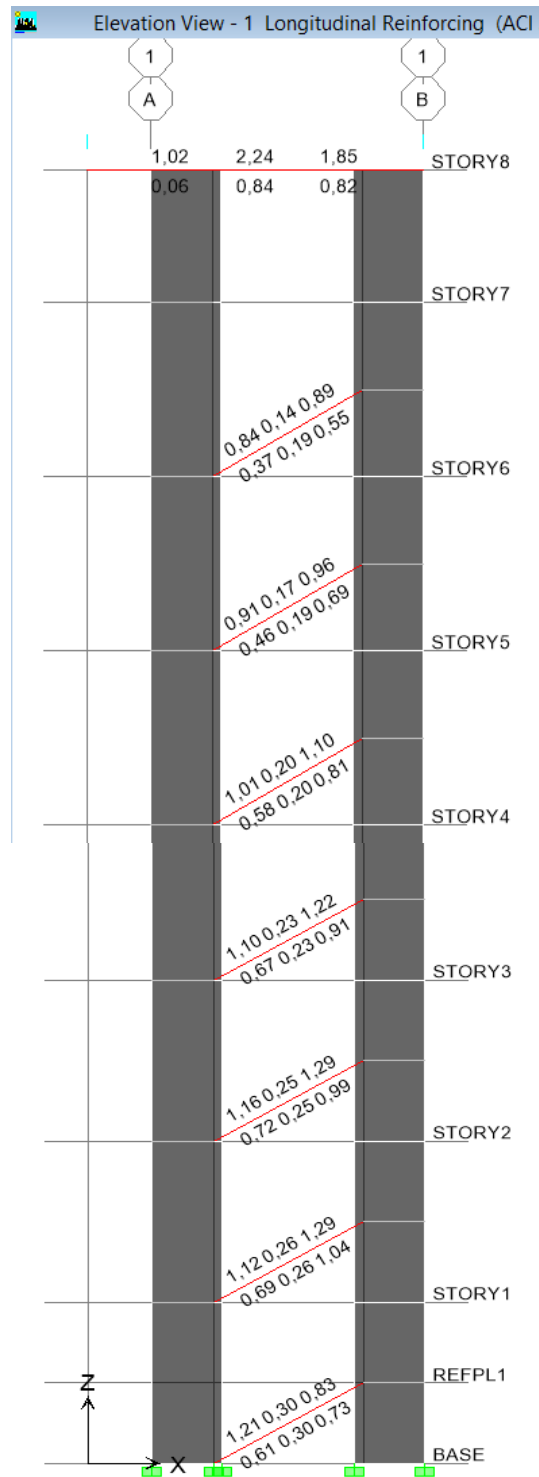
Acero en Vigas y Columnas en el Pórtico 1 – Escalera Emergencia Hospitalización 2- (CEC-2002)
